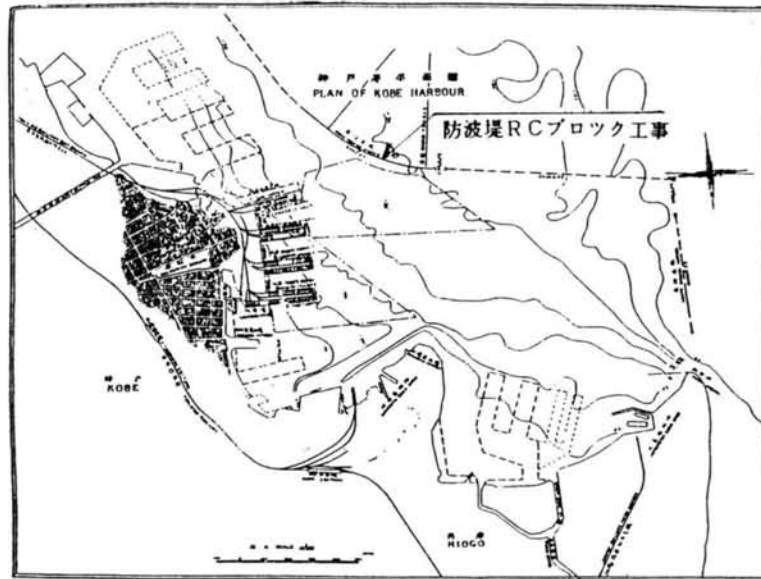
神戸港鉄筋コンクリート栈橋工事、平面図<sup>12)</sup>
